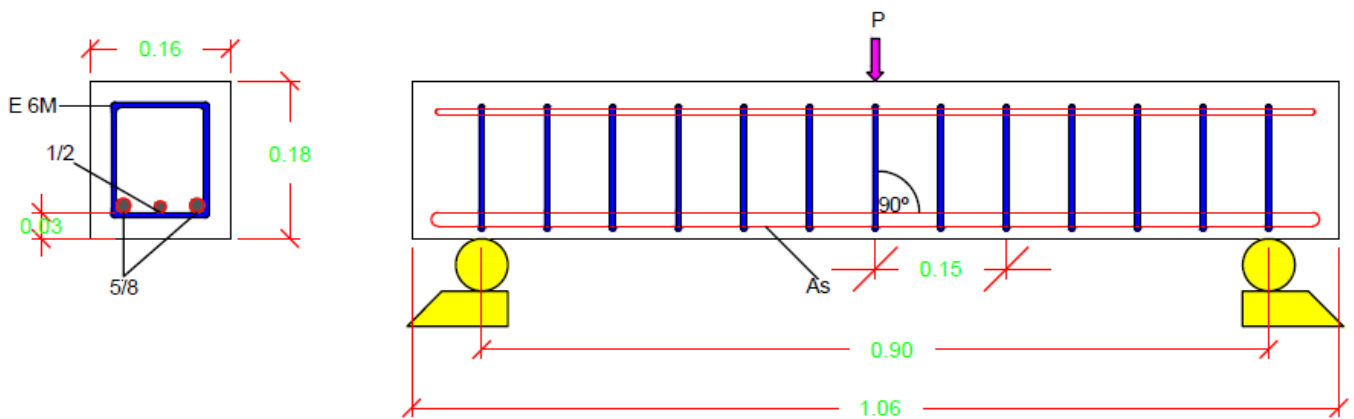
Detalle del refuerzo transversal y longitudinal de las vigas con estribos separados d/2 cm
